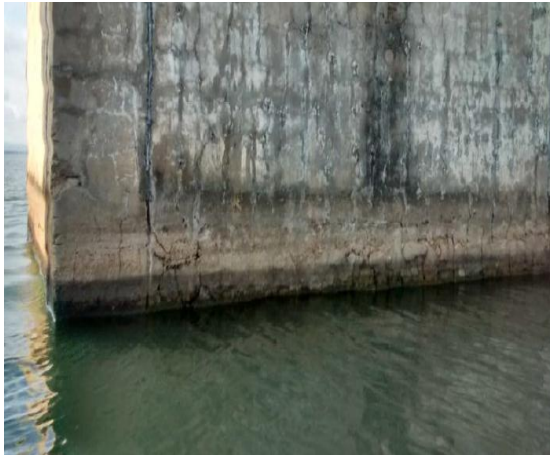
Fissuras e reação álcali-agregado na face Fátima do pilar 3.
